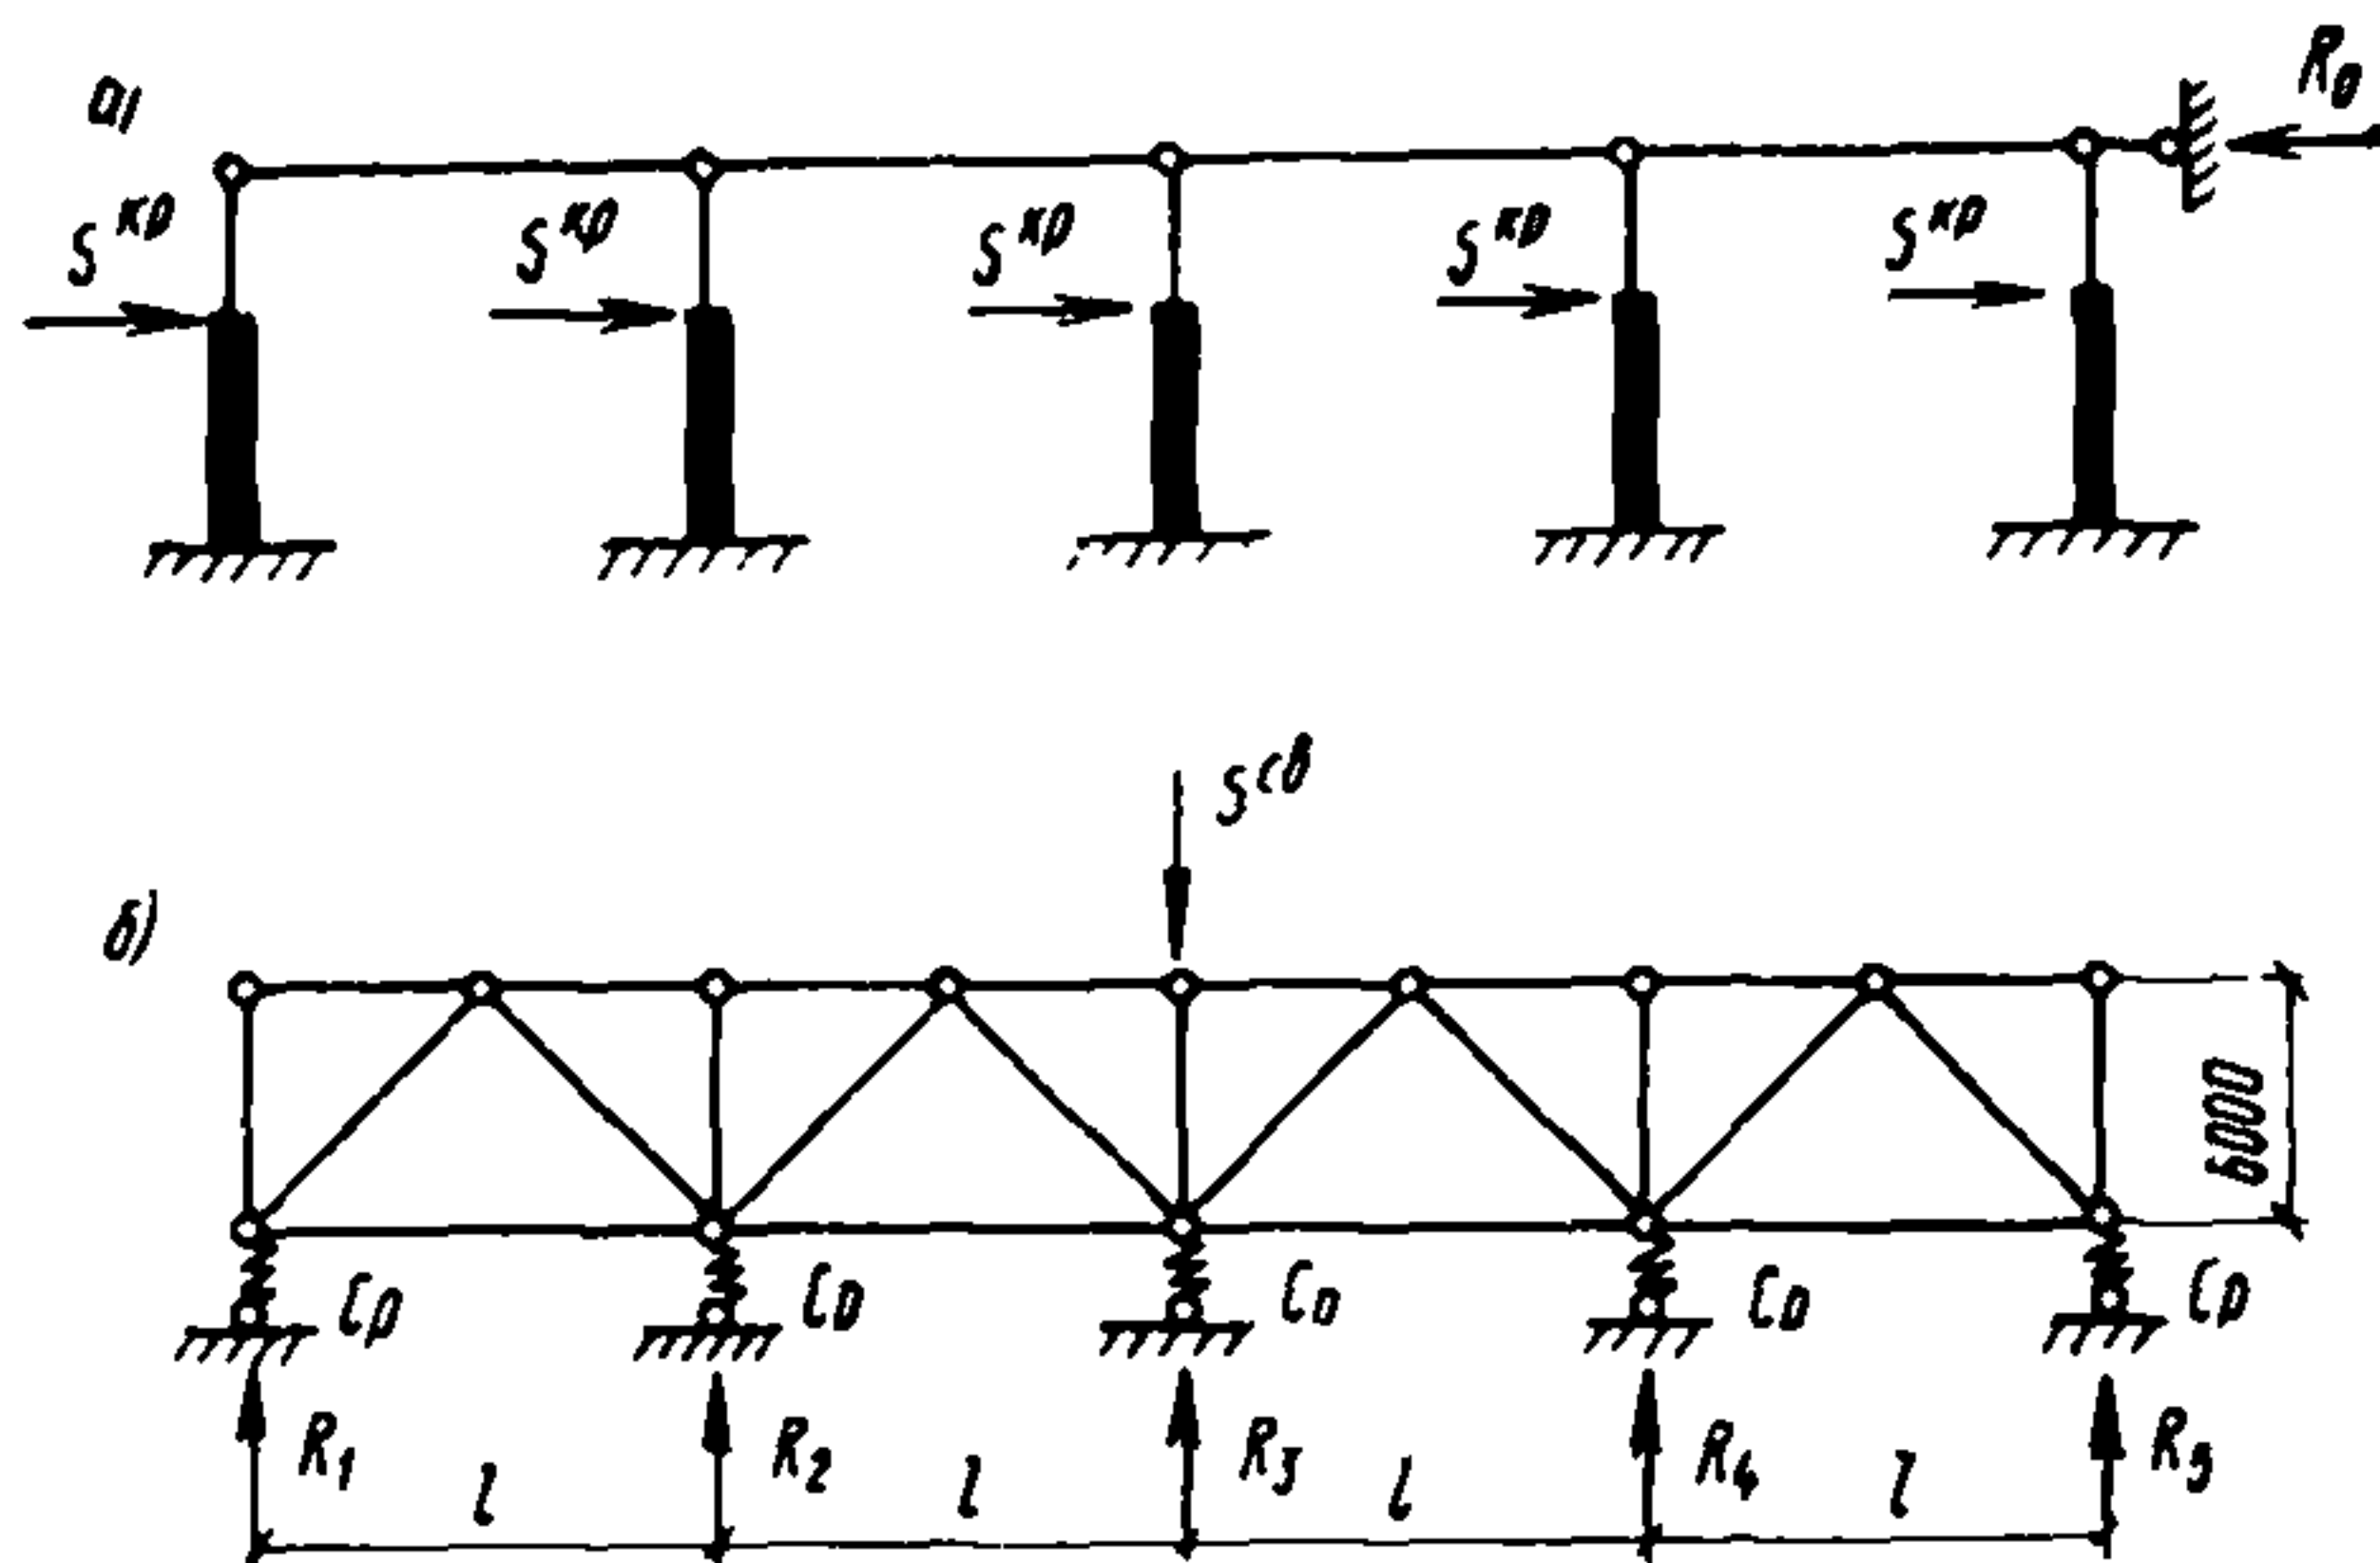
Схемы к расчету продольных связей по нижним поясам стропильных ферм на сейсмическую нагрузку от мостовых кранов
